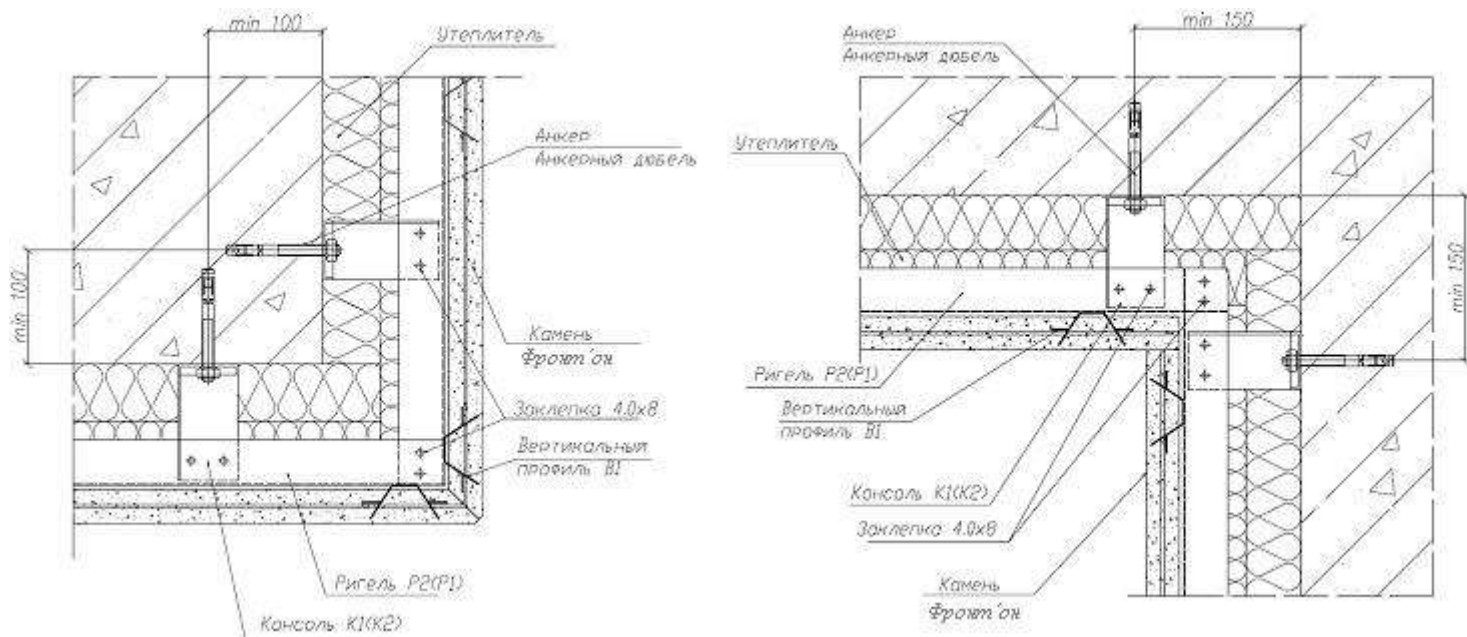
Схема сборки несущей конструкции на наружном и внутреннем углах здания
